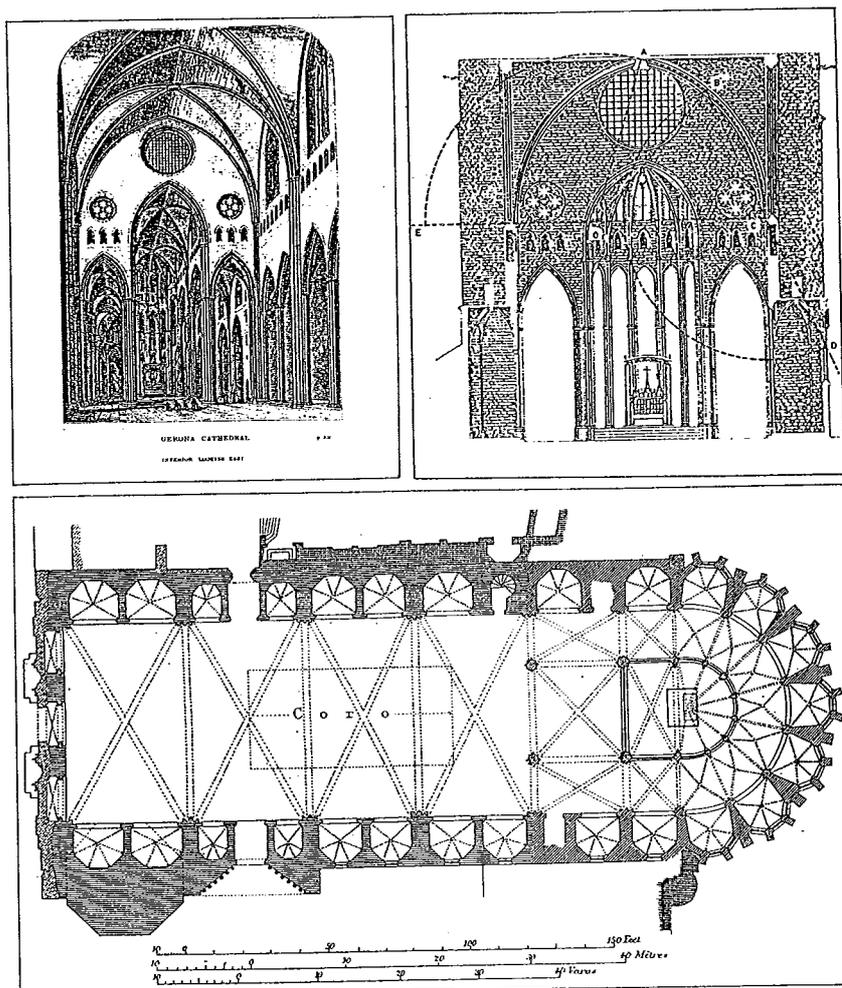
Catedral de Gerona. Planta, sección y vista interior
